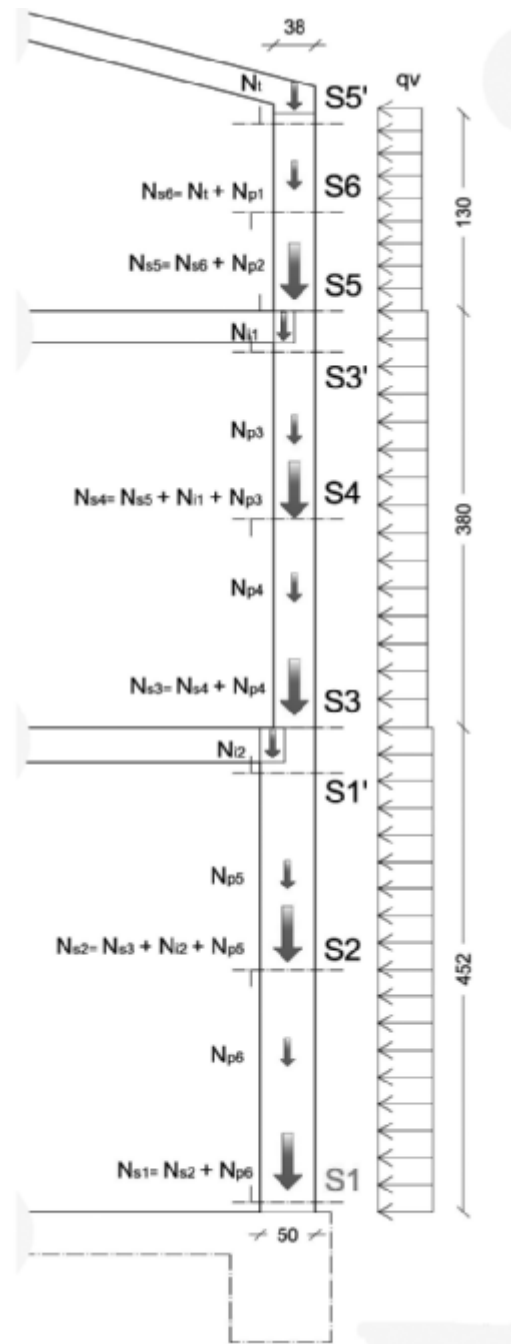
Lo schema illustra i carichi statici agenti sulle diverse sezioni orizzontali della porzione di parete su via Saffi. Per la sezione S1 la verifica a compressione media non è soddisfatta.
